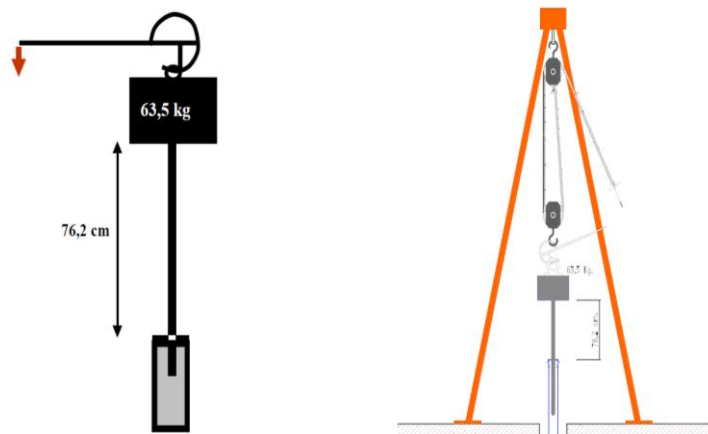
Pistón de 0.622 KN utilizado para ejecutar el ensayo de SPT
